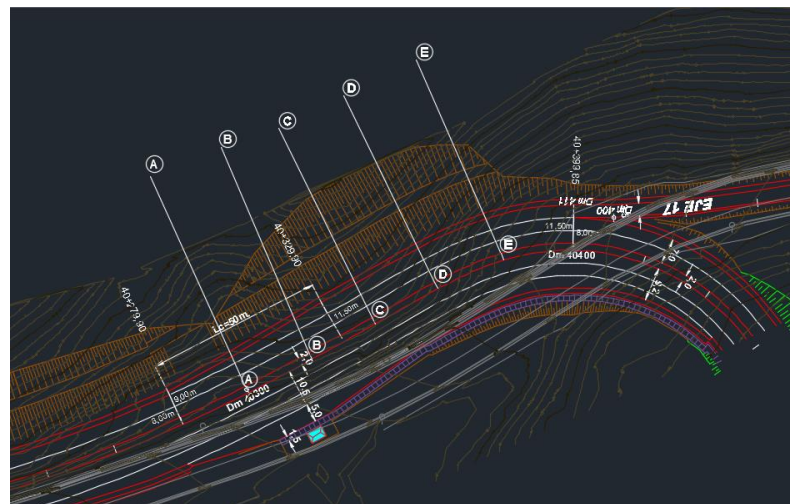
Vista en planta del diseño inicial del talud y ubicación de perfiles transversales. (Fuente: empresa).
